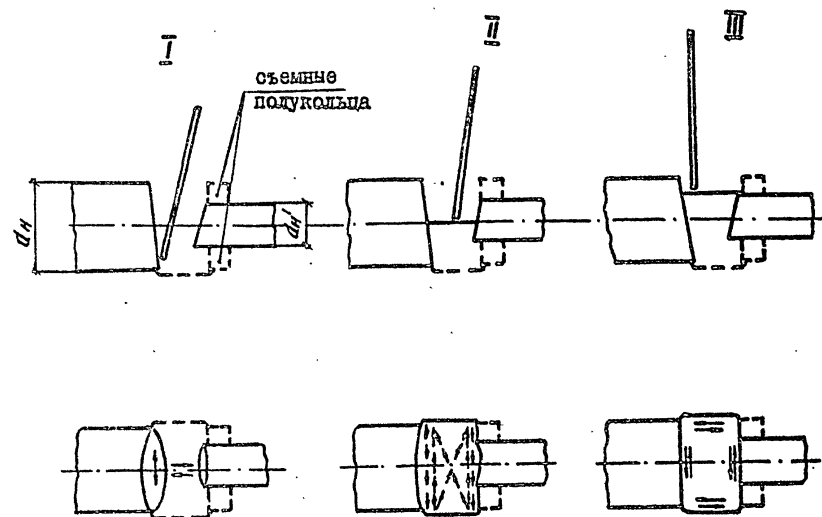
Техника механизированной сварки горизонтальных выпусков арматуры в инвентарной форме, размеры которой регламентированы для сварки стержня большего диаметра.
